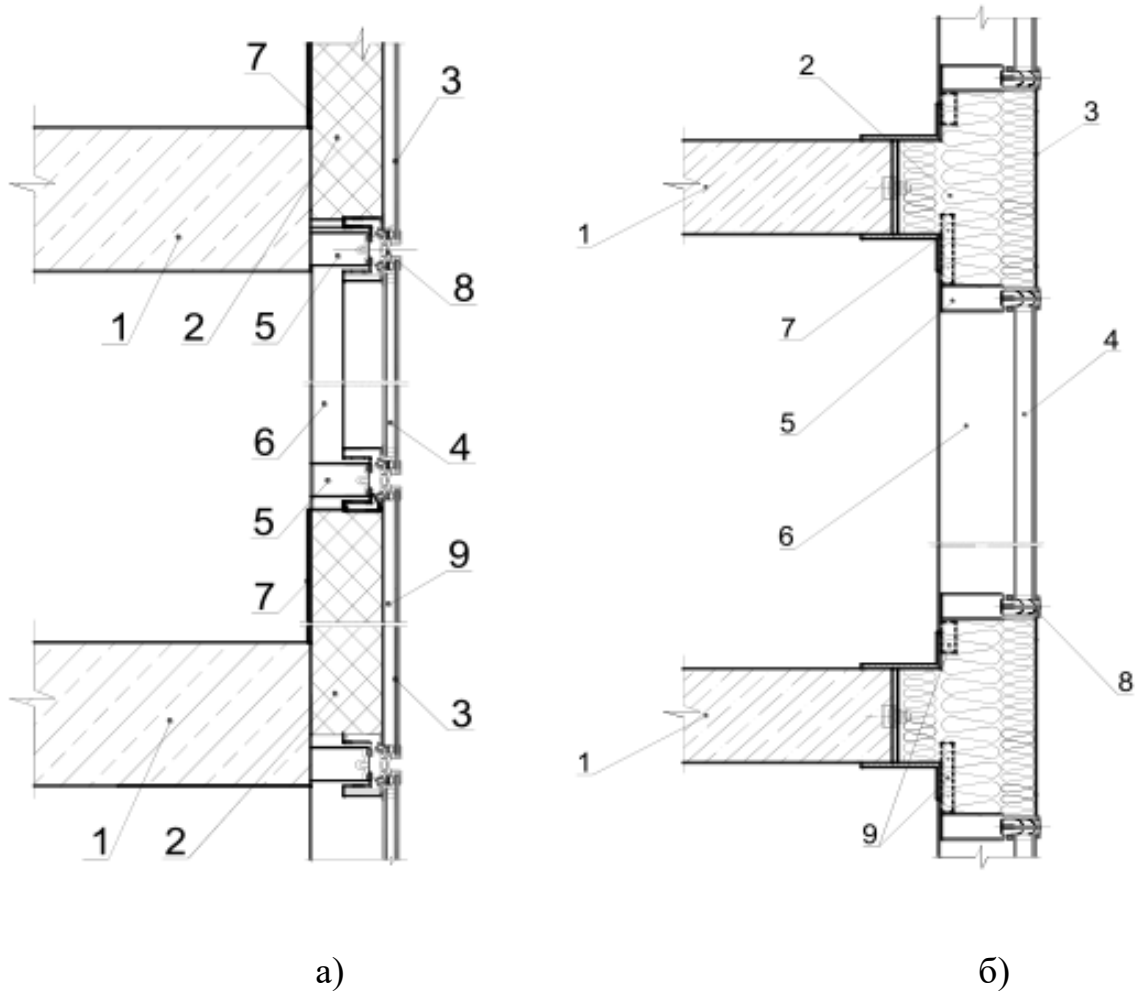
Конструктивні схеми зовнішніх стін з комбінованим світлопрозорим фасадом (а) та з суцільним світлопрозорим фасадом, де утеплювач використовується для ізоляції плит перекриттів (б):
